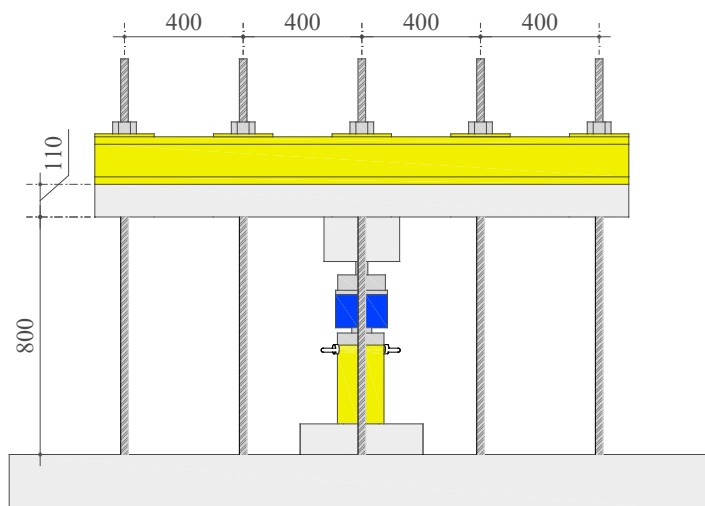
Detalhe lateral do sistema de ensaio (mm)
